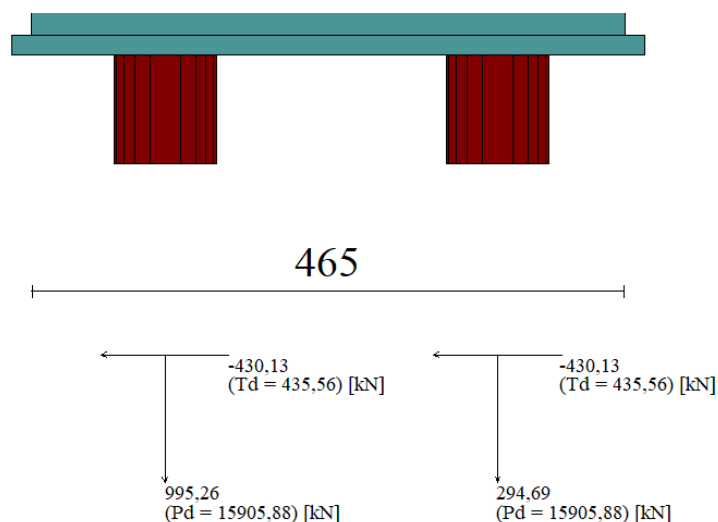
Sollecitazioni massime a testa palo dei MURI DI CONTRORIPA - FONDAZIONE SU PALI - TIPO 1
